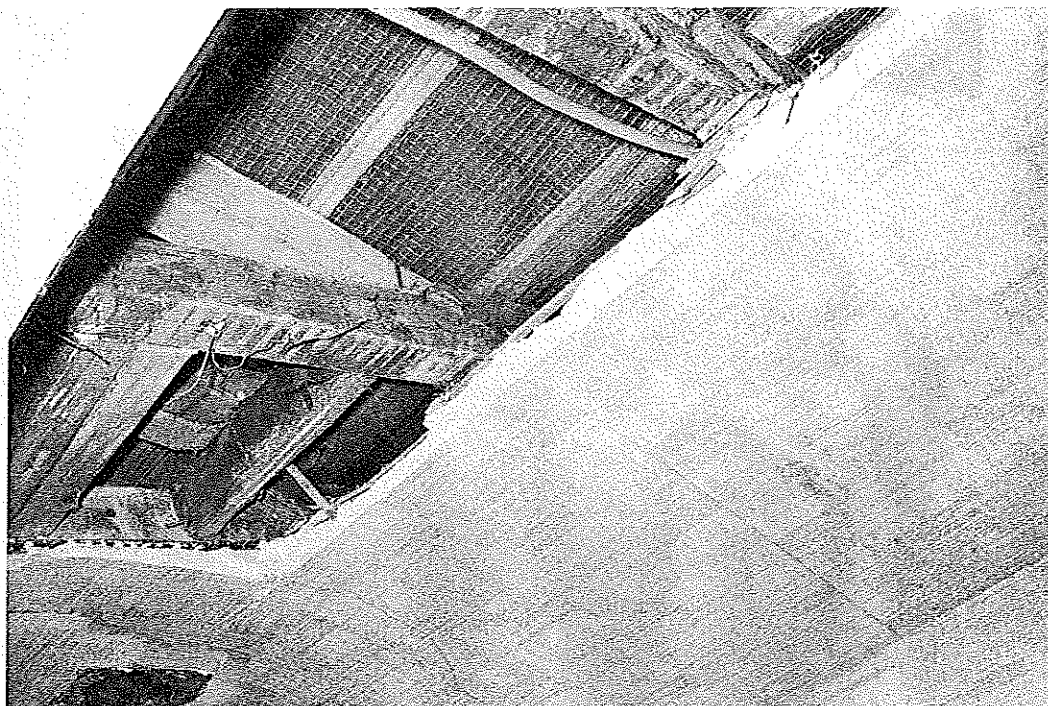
Sondage dans la sous-toiture, zone de lucarne. Raccordement coyaulure sur ancien chevron. © J. Putatti
